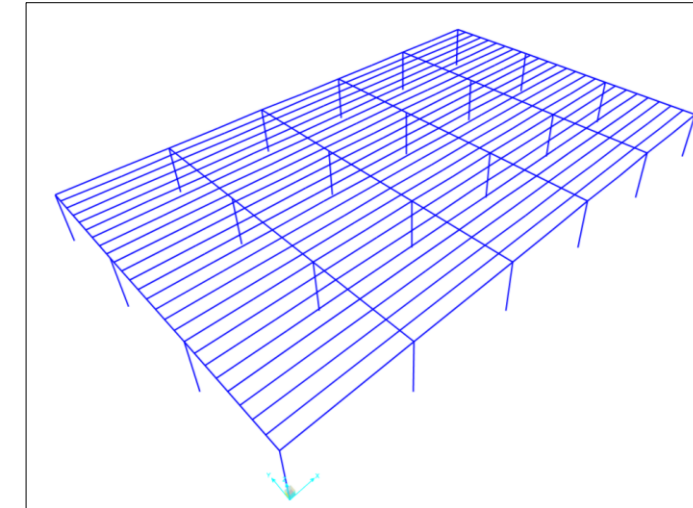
a. Modelización de la estructura de hormigón prefabricado. Sala de ventas
